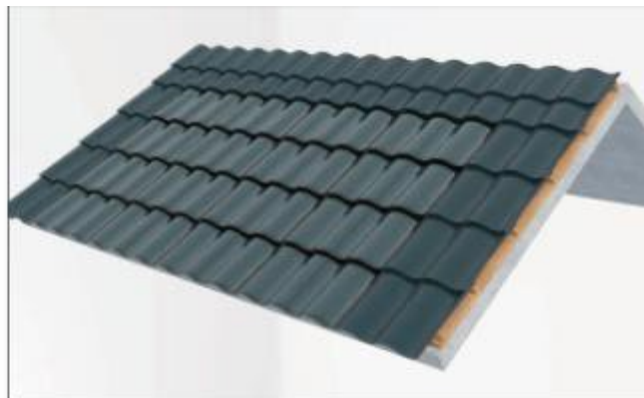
Установка боковой плитки на бетонной крыше
